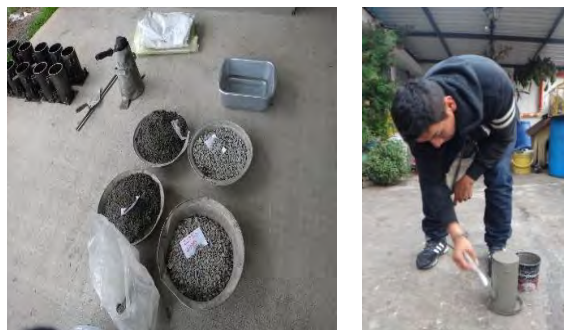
Materiales y elementos utilizados para la elaboración de los especímenes de concreto, e impregnación superficial con activos en muestras prefisuradas.
